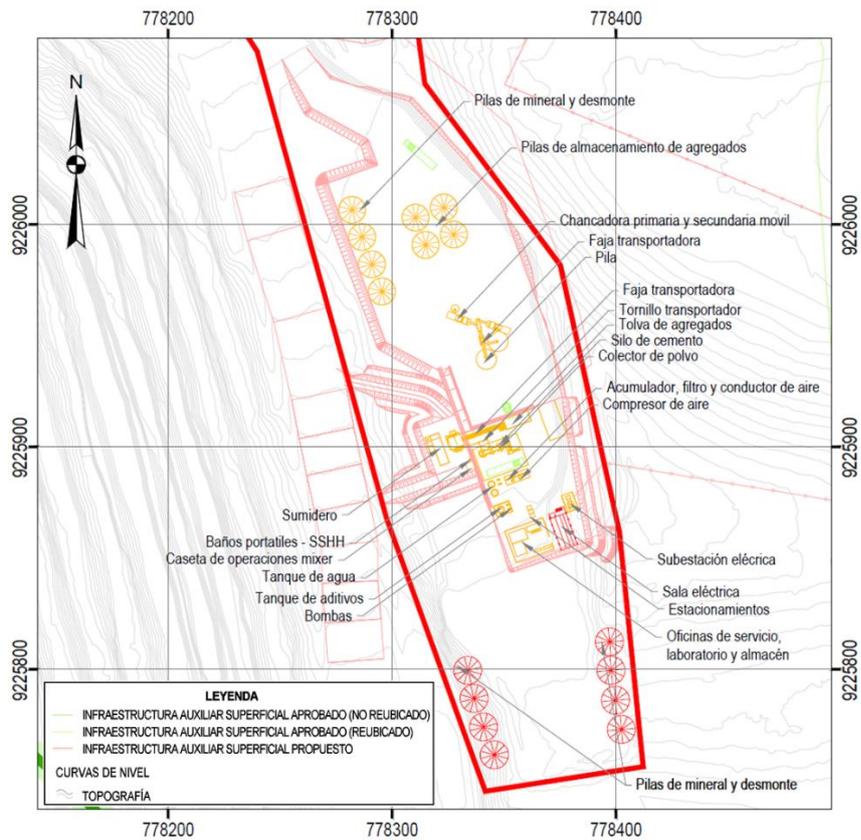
Segunda planta de relleno cementado, shotcrete y concreto, y planta de chancado y clasificación de agregados en el Área 8
